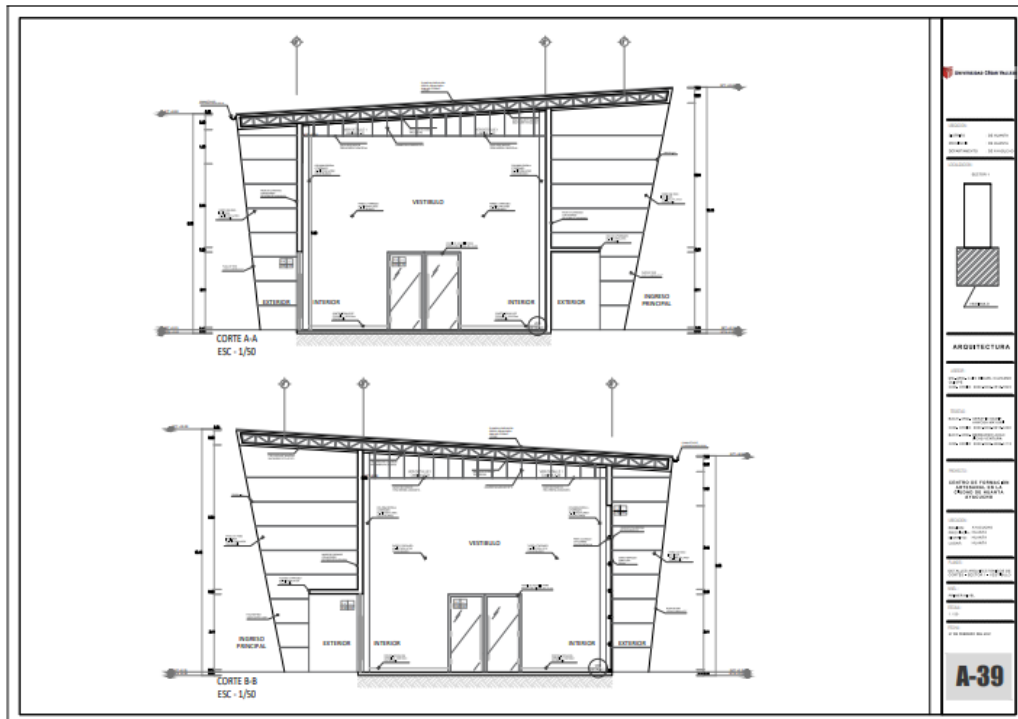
Detalles arquitectónicos por sectores escala 1/50.
